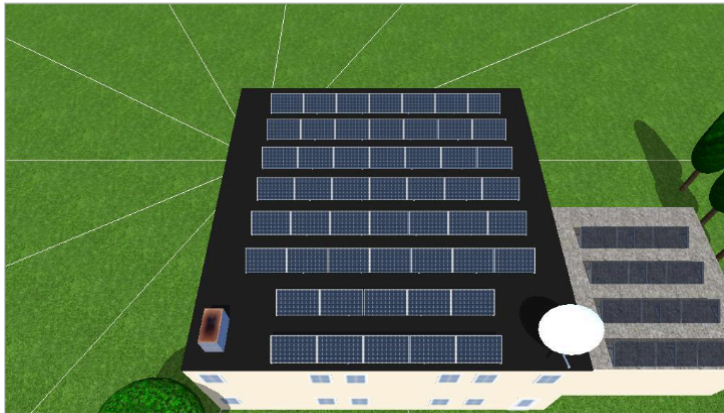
Modulfläche - Building 01-Dachfläche Nordwest
